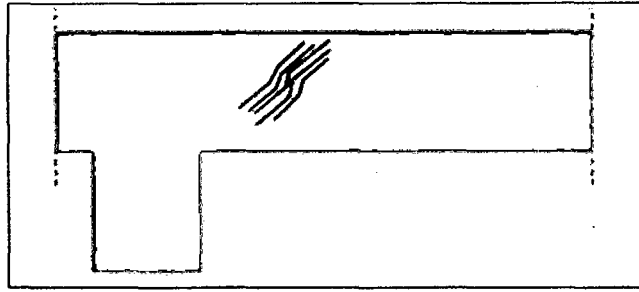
6. Fisuración por compresión oblicua del alma. Fuente: (Stuardo P., 2008)
